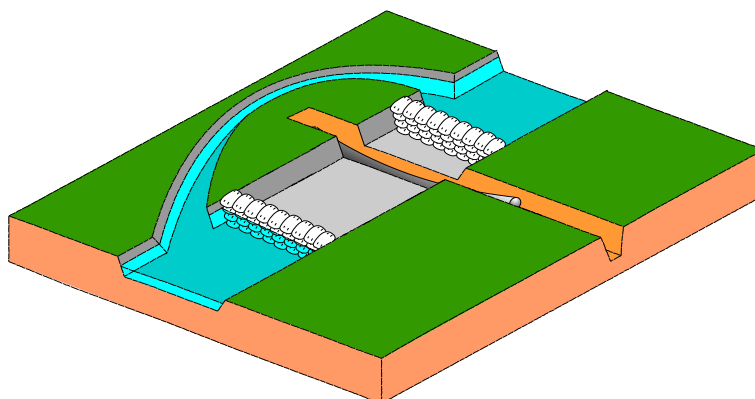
围堰导流开挖管沟法施工断面示意图
